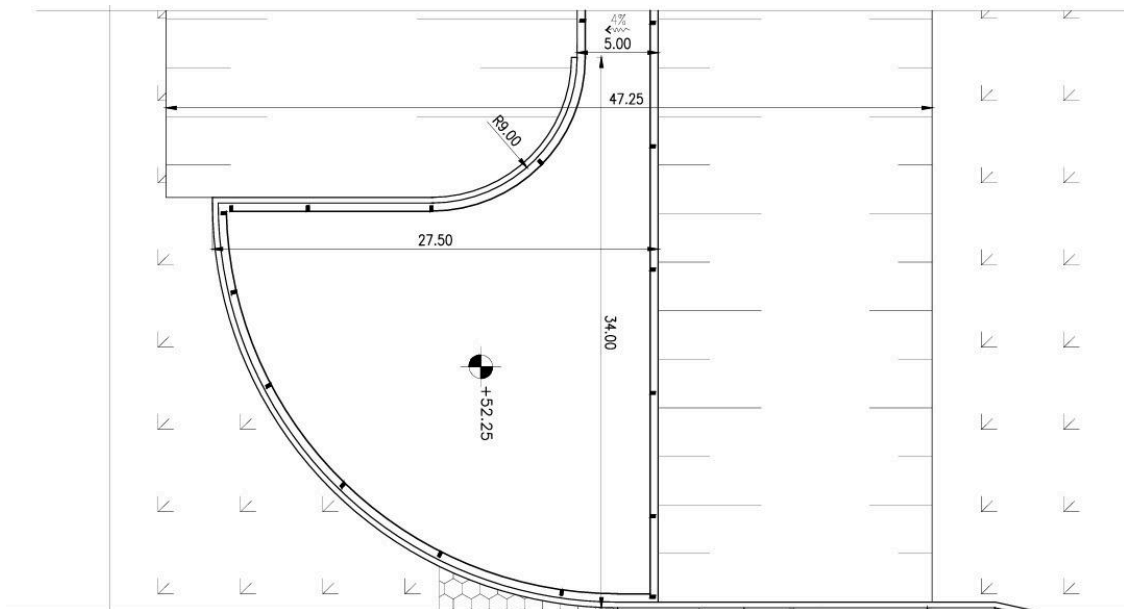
Zona cierre de presa de hormigón. Fuente: Elaboración propia.
